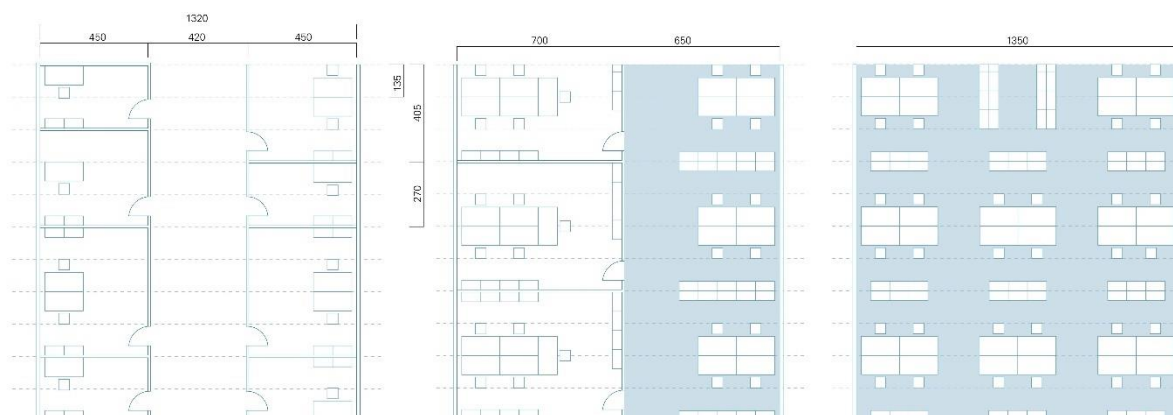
Grundrissbeispiele für Zellen-, Gruppen- und Großraumbüros [49]
